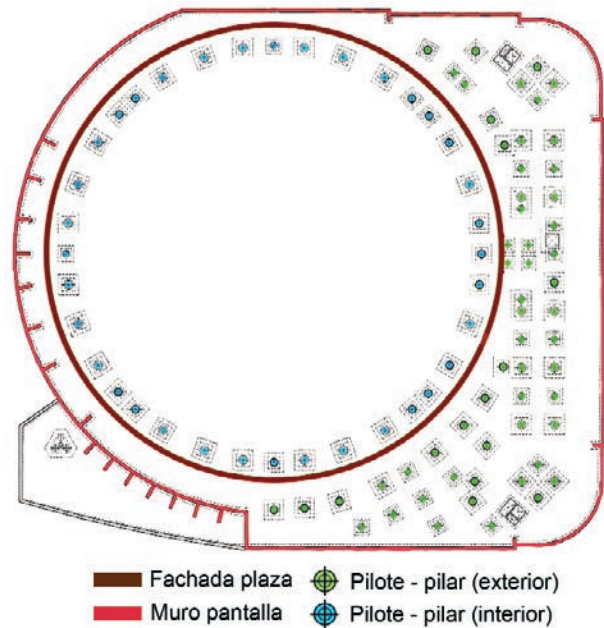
Planta de muro pantalla y cimentación profunda (pilotes-pilar)
